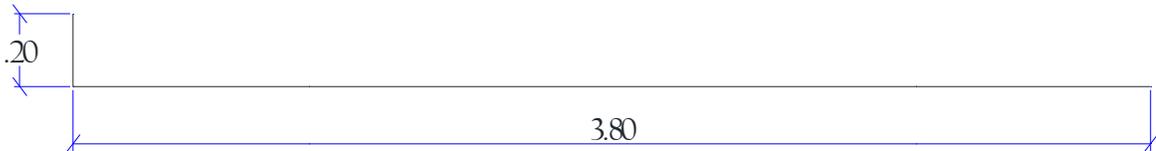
ACERO DE REFUERZO TRANSVERSAL DE LA ZARPA DEL MURO, PARRILLA INFERIRO.
